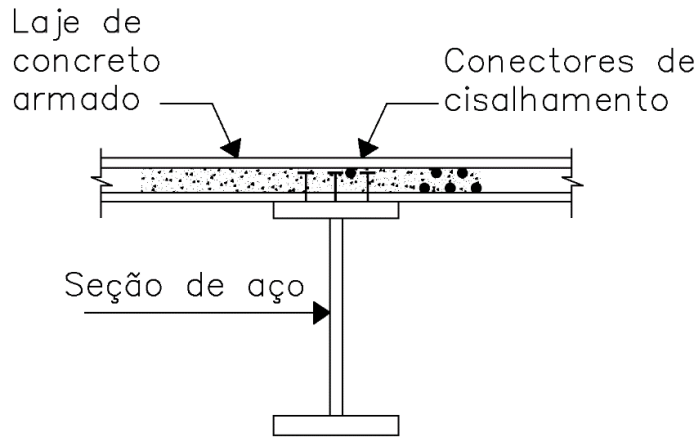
Viga típica mixta, Pfeil, W. (2008)
